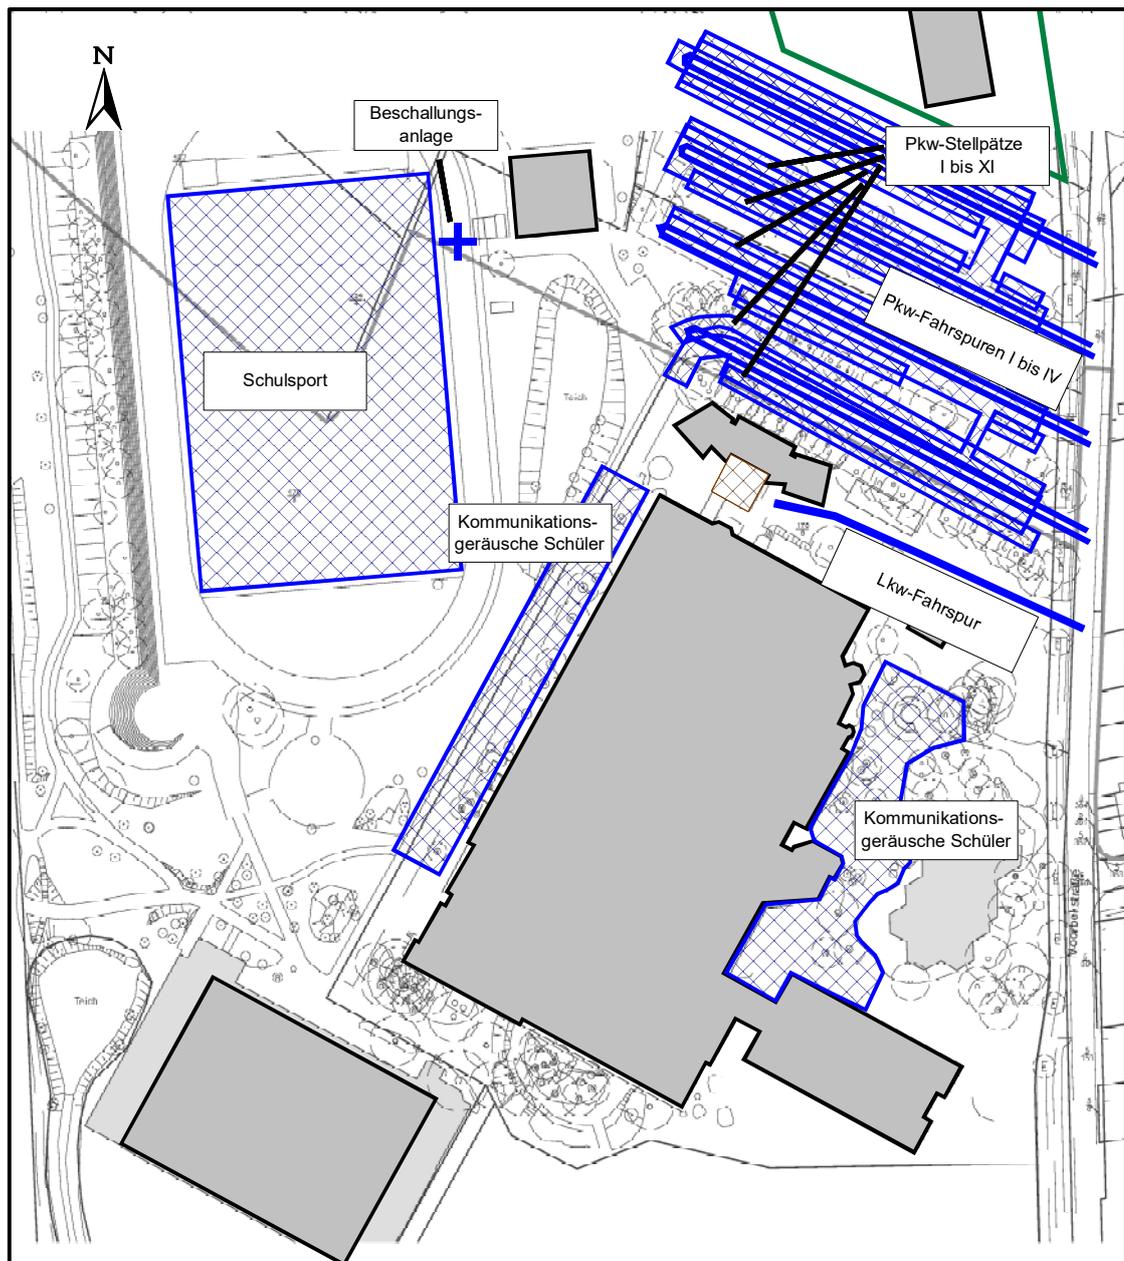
Schulbetrieb, Lageplan der Quellen, Maßstab 1 : 2.000.
